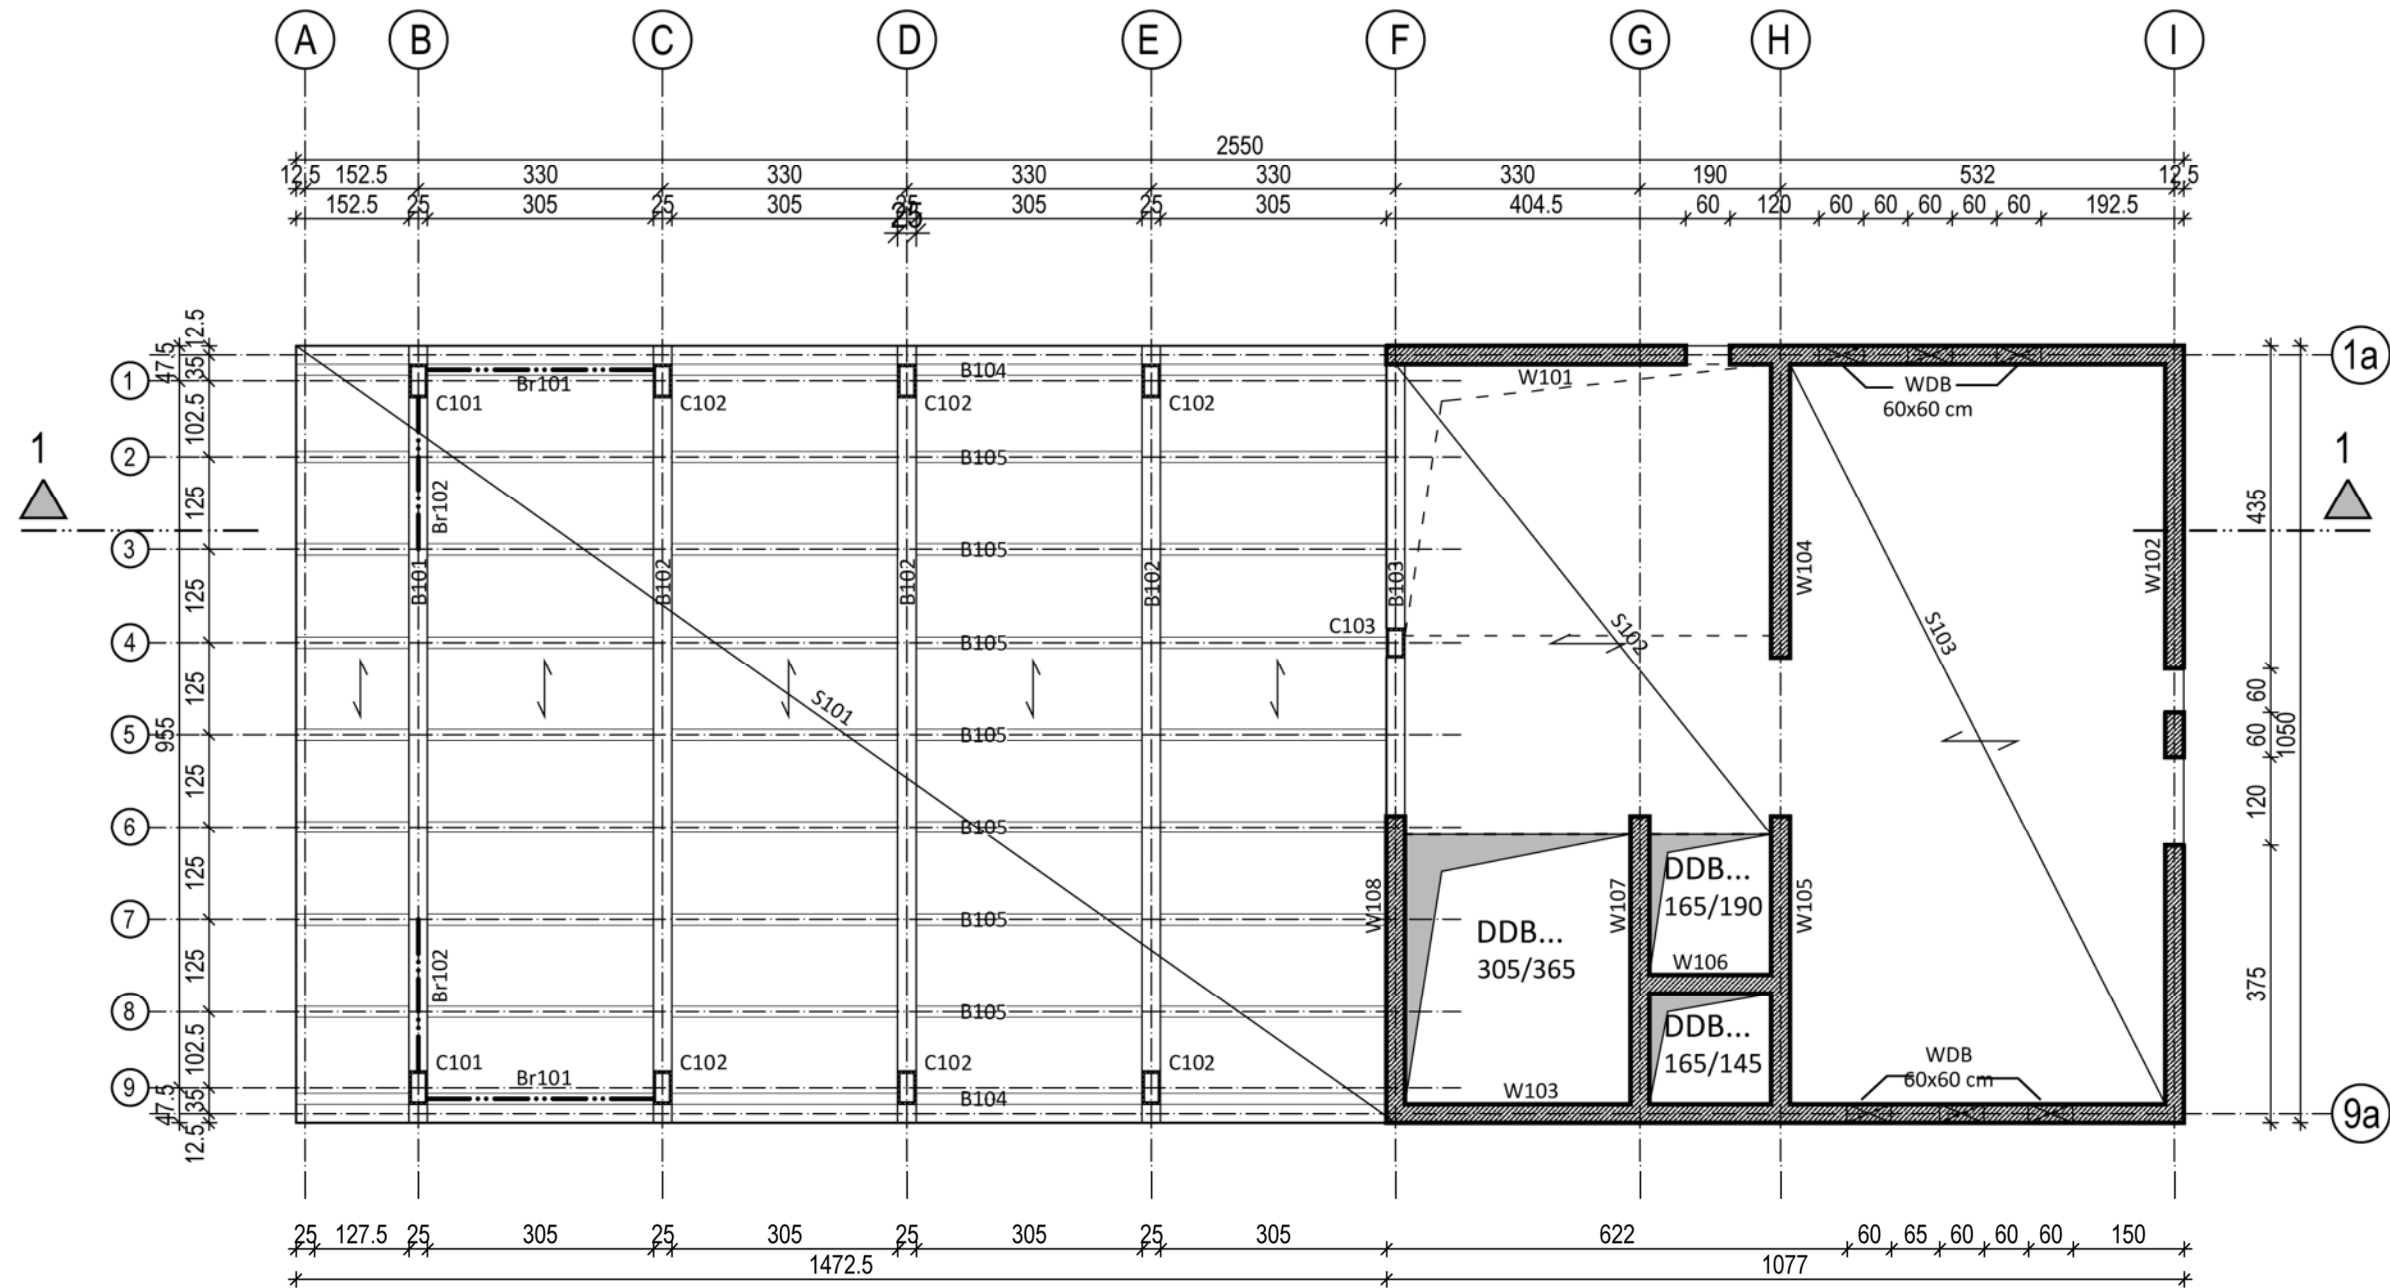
Decke über ERDGESCHOSS, M: 1:100
